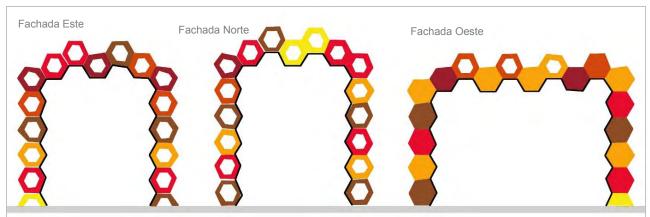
Puertas de las tres fachadas. Elaboración propia de imagen.
